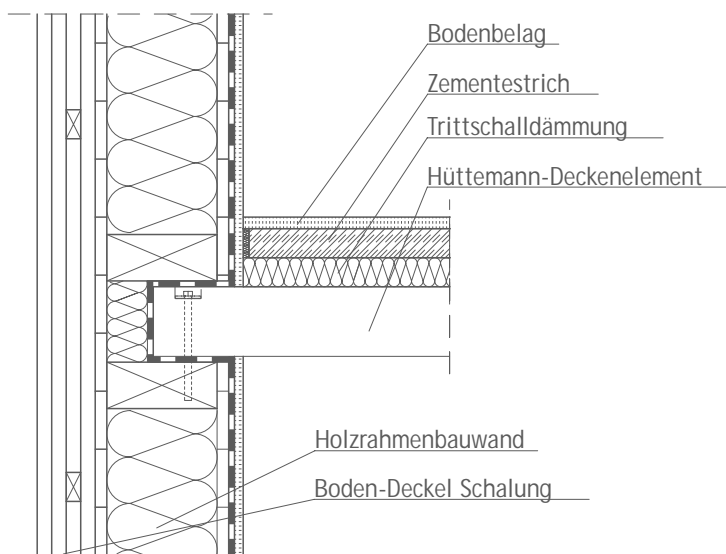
ANSCHLUSS DECKENELEMENT-RINGANKER
